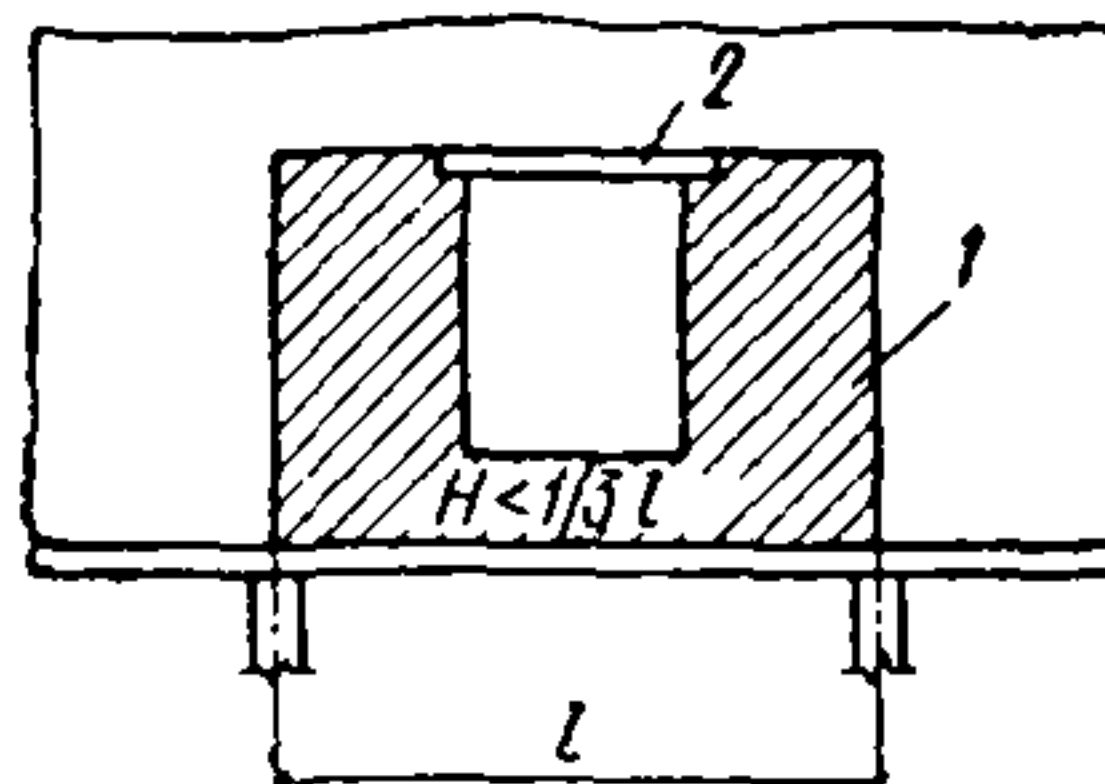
Схема нагрузки на балку в период возведения висячей стены при наличии проема
